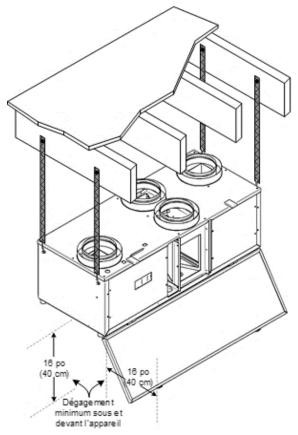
Fixation du MINOTAIR par les solives du plancher.
